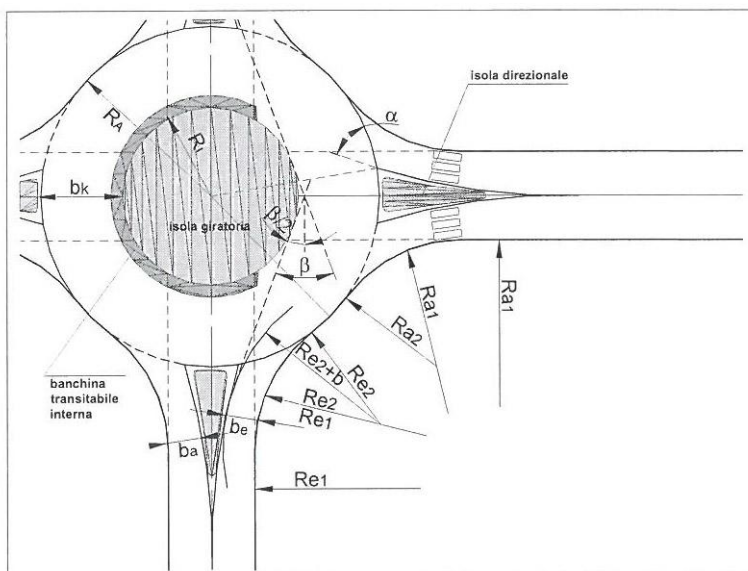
ELEMENTI DI PROGETTO DELLE ROTATORIE
